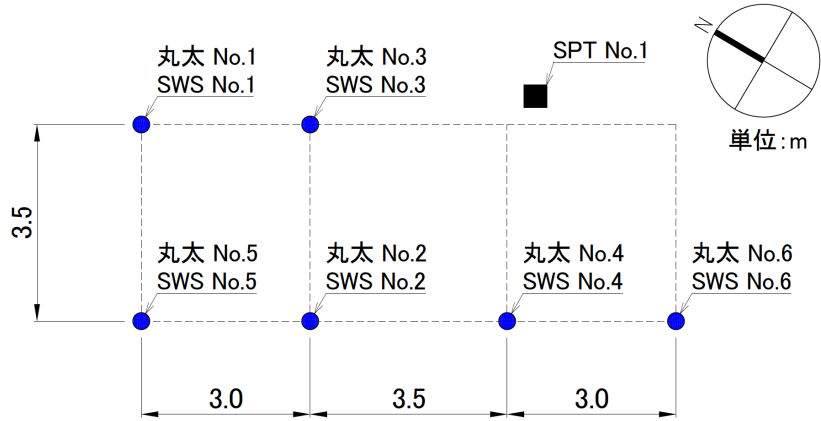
配置図と地盤調査位置 (CK 地点：千葉県木更津市)
